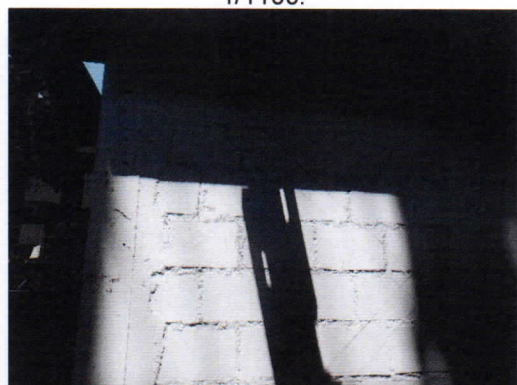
Formación de grietas diagonales en el mortero en la parte superior Este de la cara Norte para una distorsión de 1/1100.
